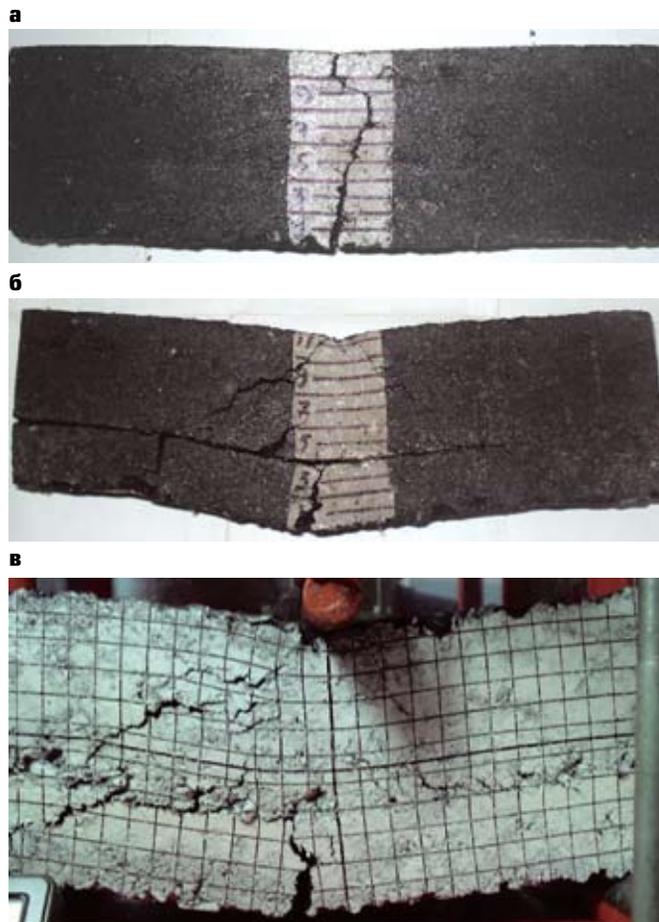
Характер разрушения асфальтобетонных образцов: а — неармированные; б, в — армированные ГМ
